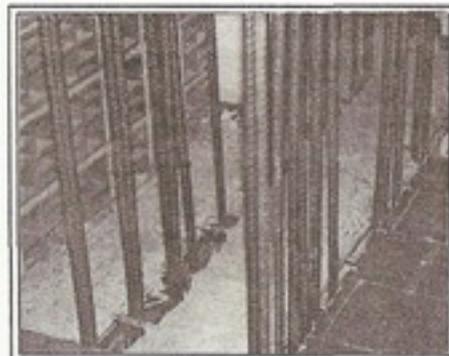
Mediante perforación de vigas y losas de piso se logra dar continuidad a las barras de refuerzo verticales.
